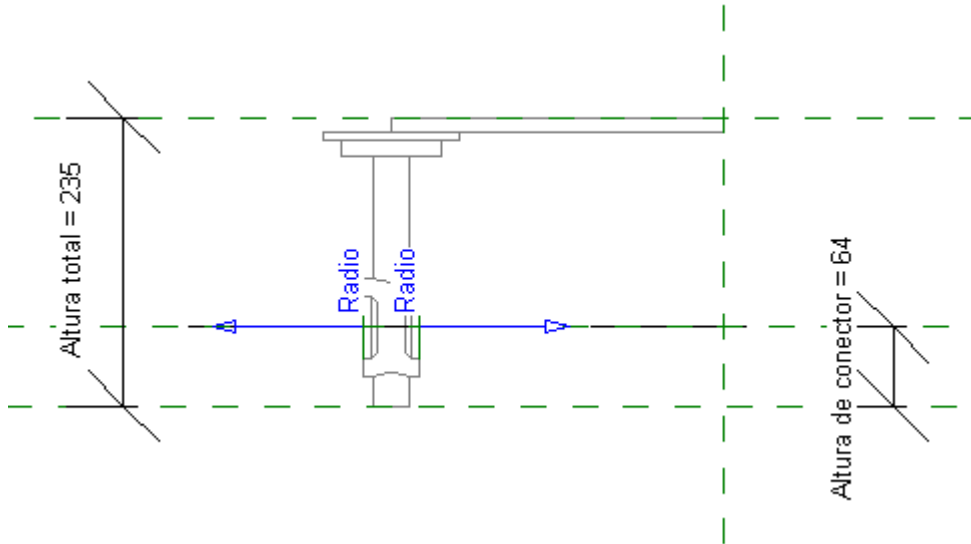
Alzado válvula de mariposa biblioteca Revit
